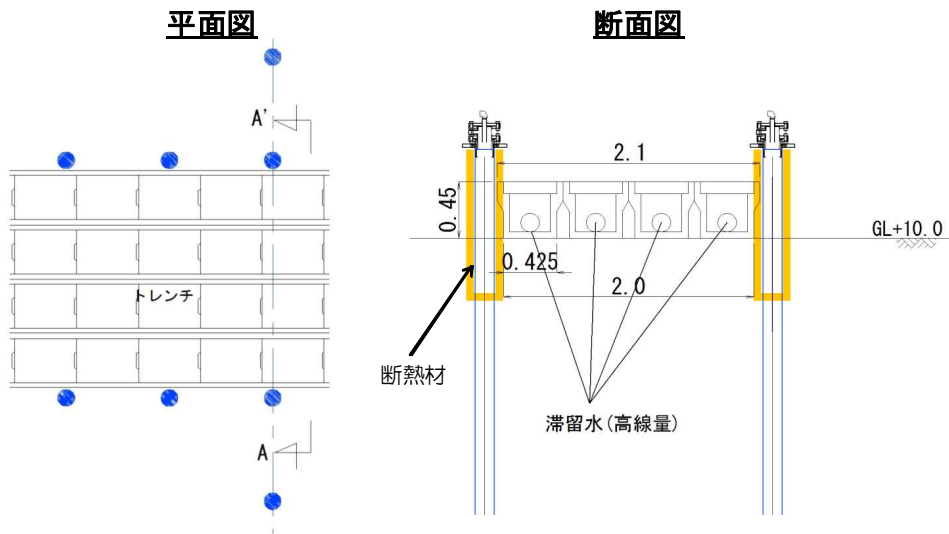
【7-5】 廃棄物系共通配管ダクト② 施工方法（貫通施工）
